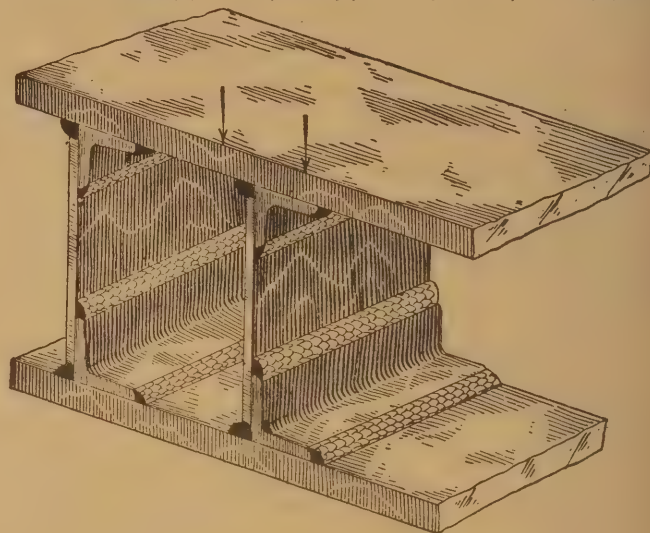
Lichtbogenschweißung für eisernen Träger.
